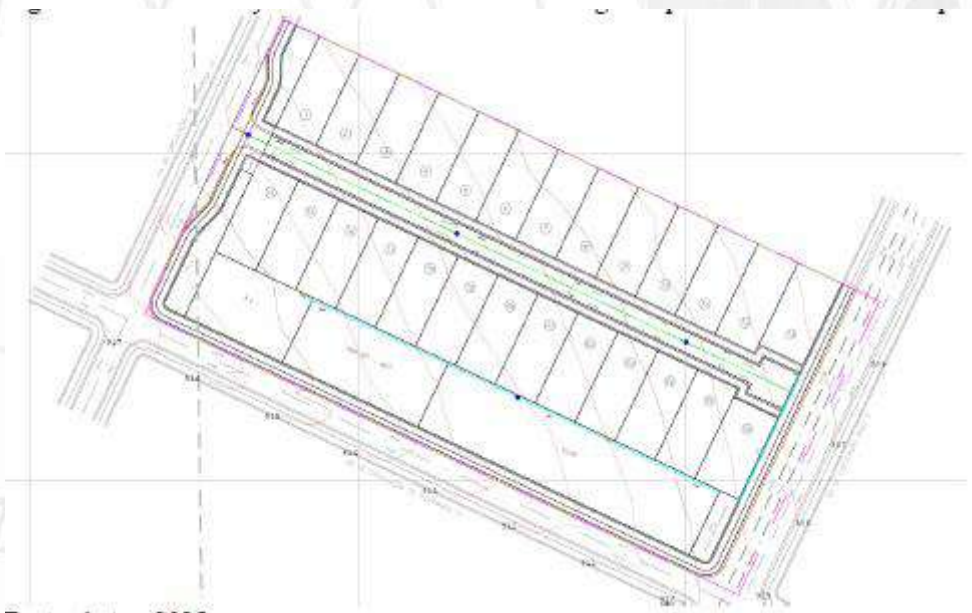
Layout do sistema de drenagem pluvial – Solarium Ipê
